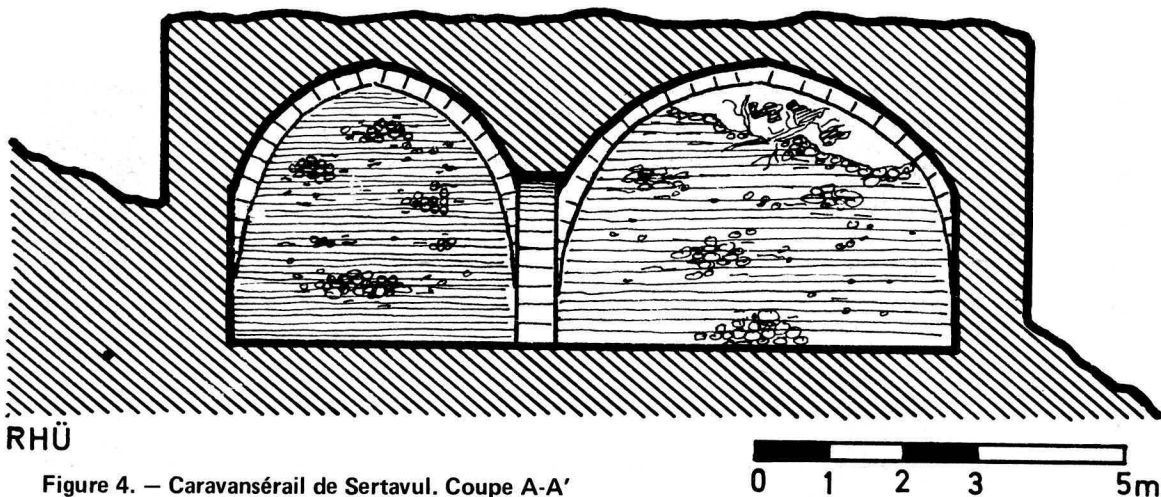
Caravansérail de Sertavul. Coupe A-A'
